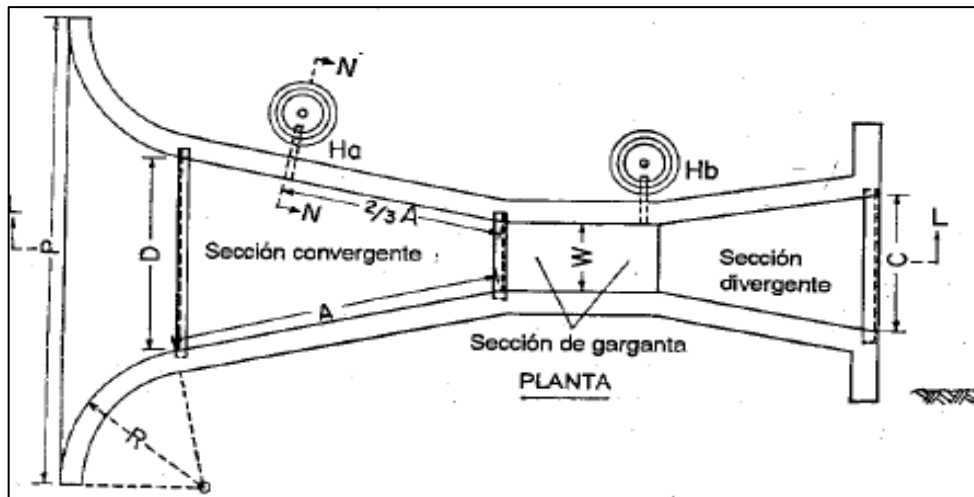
Nomenclatura de las dimensiones de una canaleta Parshall (vista planta).
